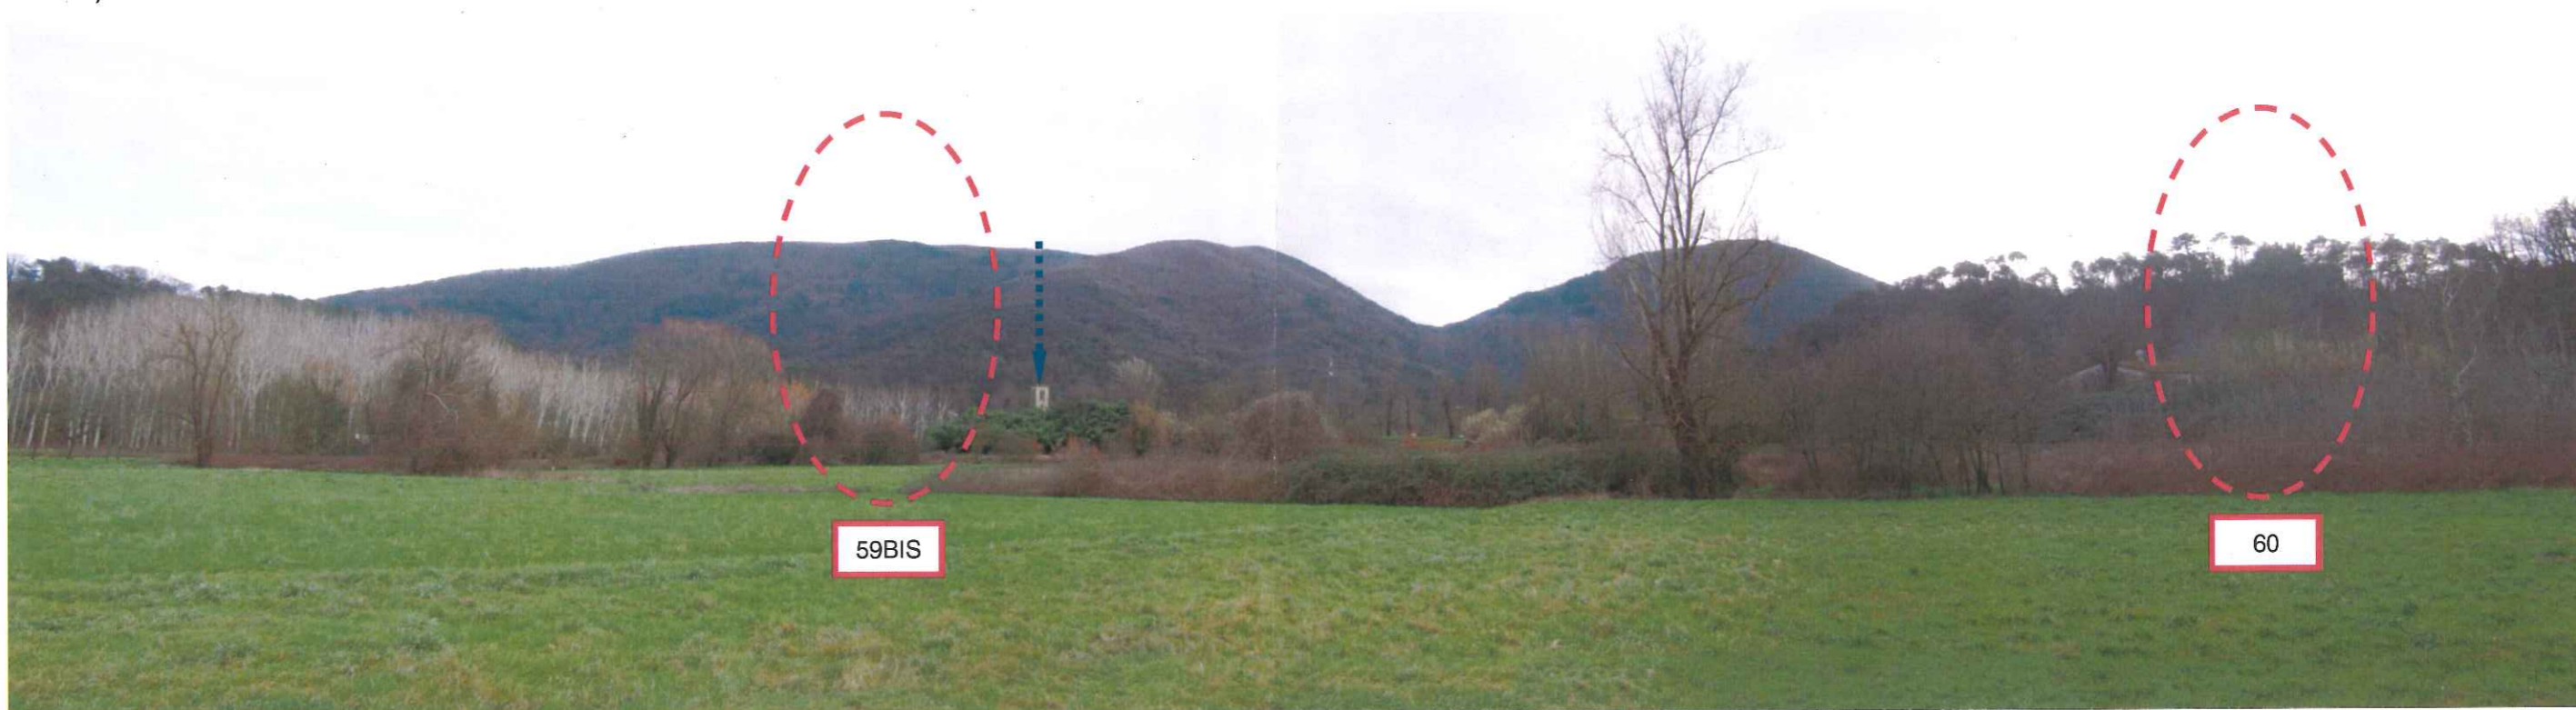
Vista da via di Cerasomma in direzione sud-est verso la frazione di Cerasomma in prossimità del sottopasso autostradale A11 Firenze/Mare situato alle spalle. La freccia blu indica il campanile della Chiesa di S. Pietro a Cerasomma. Le aree tratteggiate individuano la posizione, approssimativa, dei sostegni 60 e 59bis della variante autorizzata da non realizzare.
